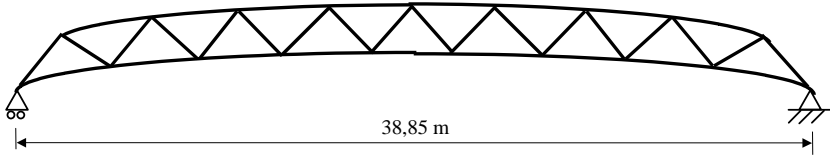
Passerelle à poutres latérales de type Warren
